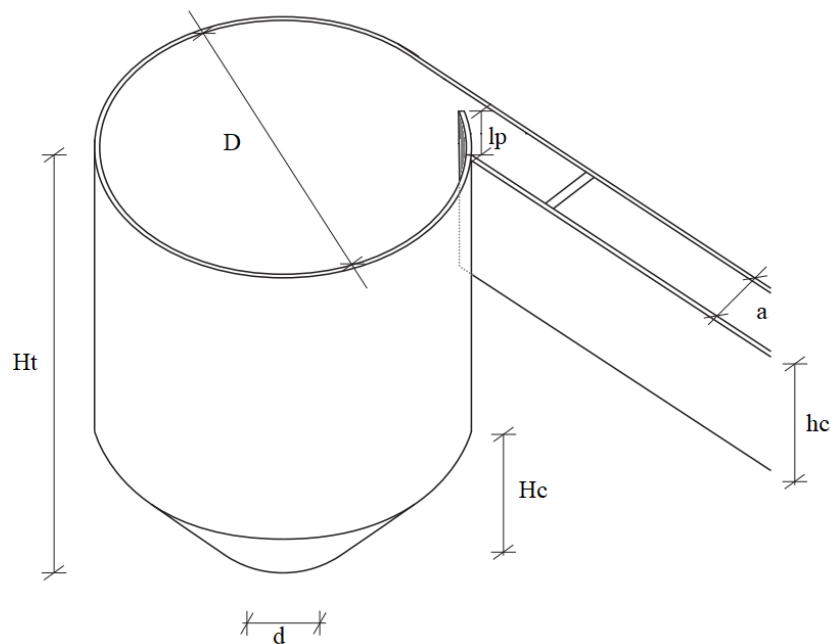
Geometría y dimensiones del Tanque de Circulación.
